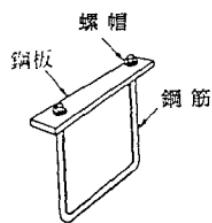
增設腹筋進行梁剪力補強之示意圖
